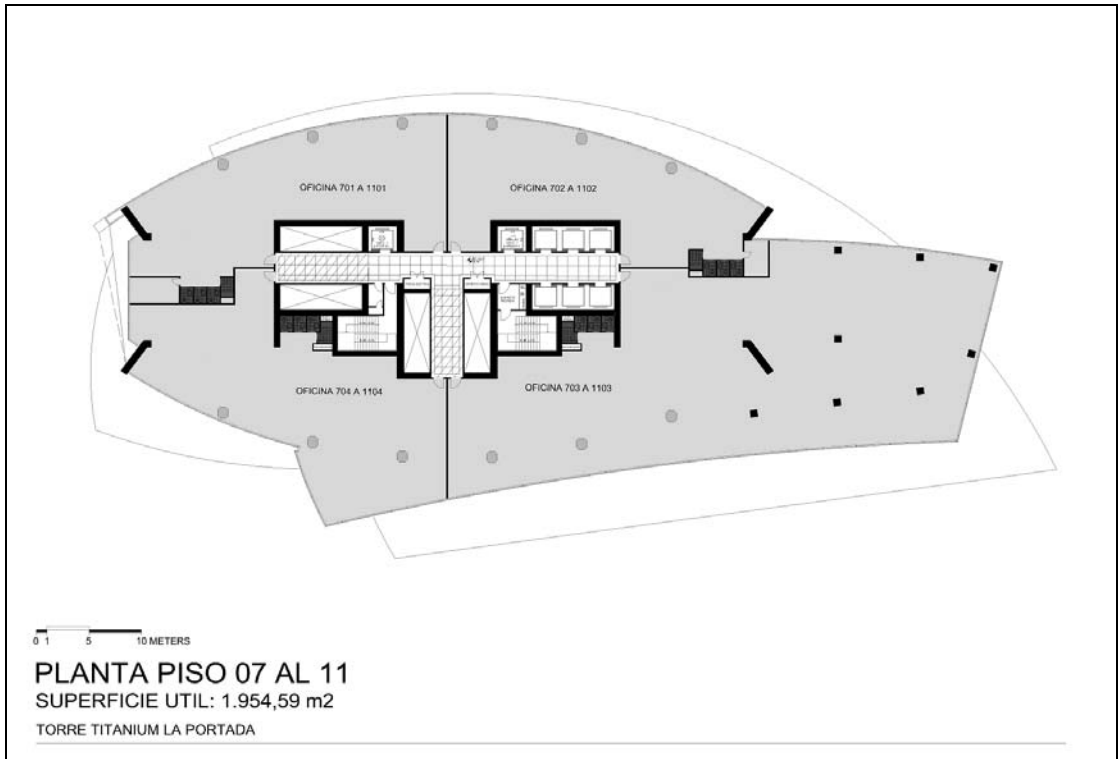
5. Planta Pisos 7 al 11. Fuente: *ASL Sencorp.
